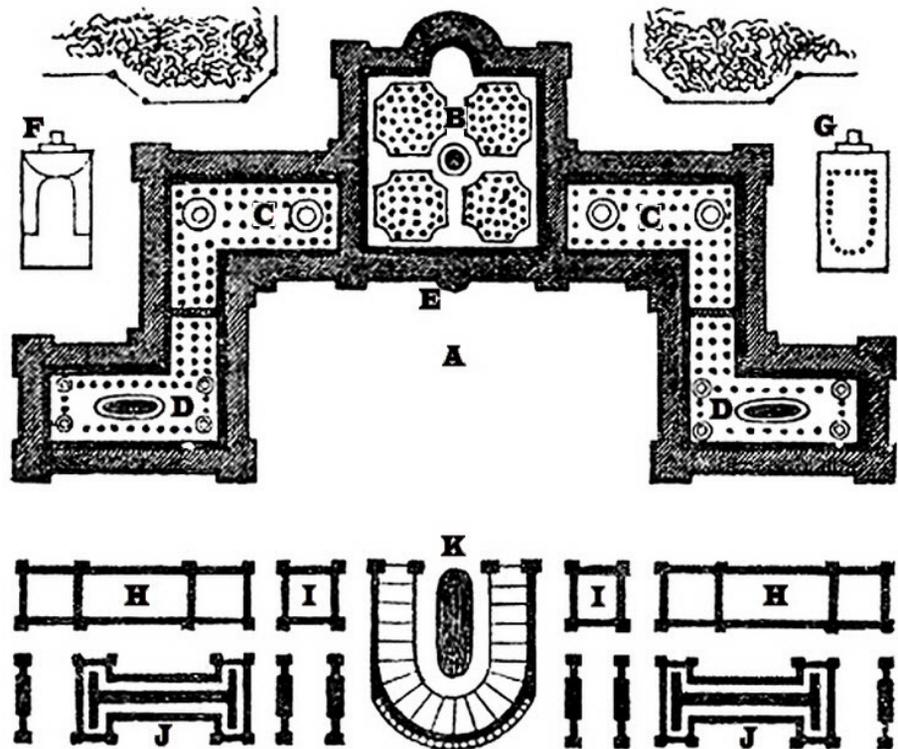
Phalanstère, Grundriss, 1829
